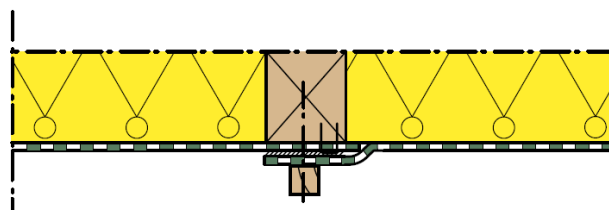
Assemblage de deux pans d'une membrane pare-air au droit d'un élément de structure en bois par chevauchement, collage et pose d'un contre-lattage.
